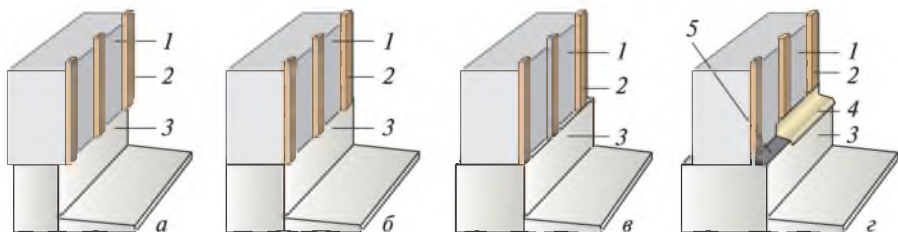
Виды цоколей: а – западающий; б – ровный; в – выступающий (выровненный обрешеткой со стеной); г – выступающий с отливом поверх обрешетки; 1 – стена; 2 – обрешетка; 3 – цоколь; 4 – виниловый отлив Döcke; 5 – цементная стяжка
